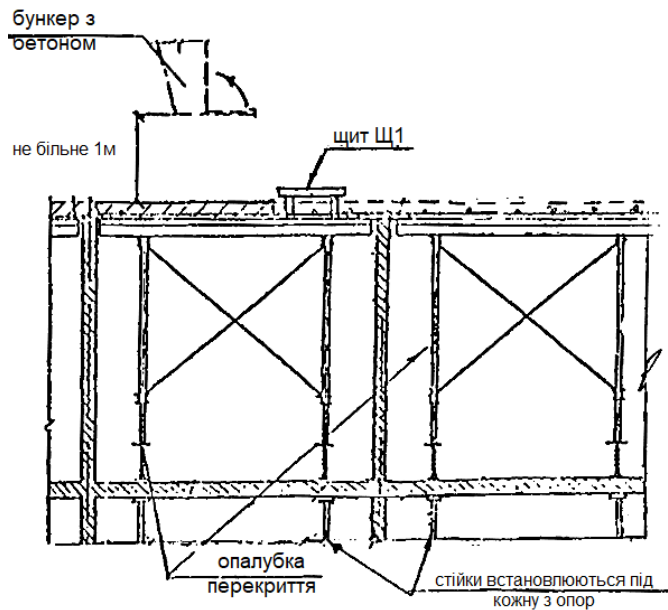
Вивантаження бетонної суміші з бункера в опалубку
